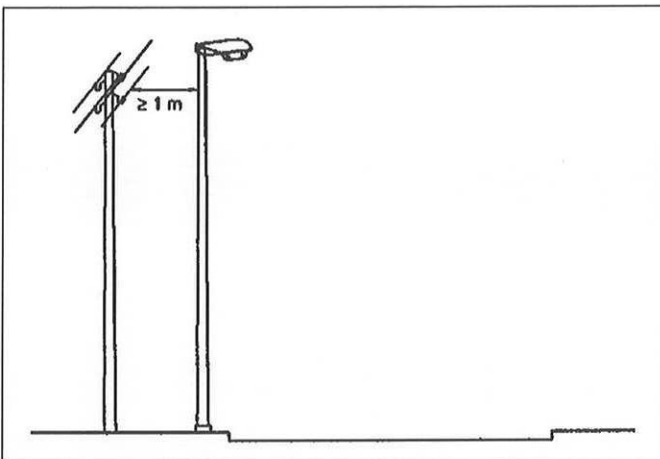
Distanza di rispetto tra apparecchi illuminanti e linee aeree nude di bassa tensione.
